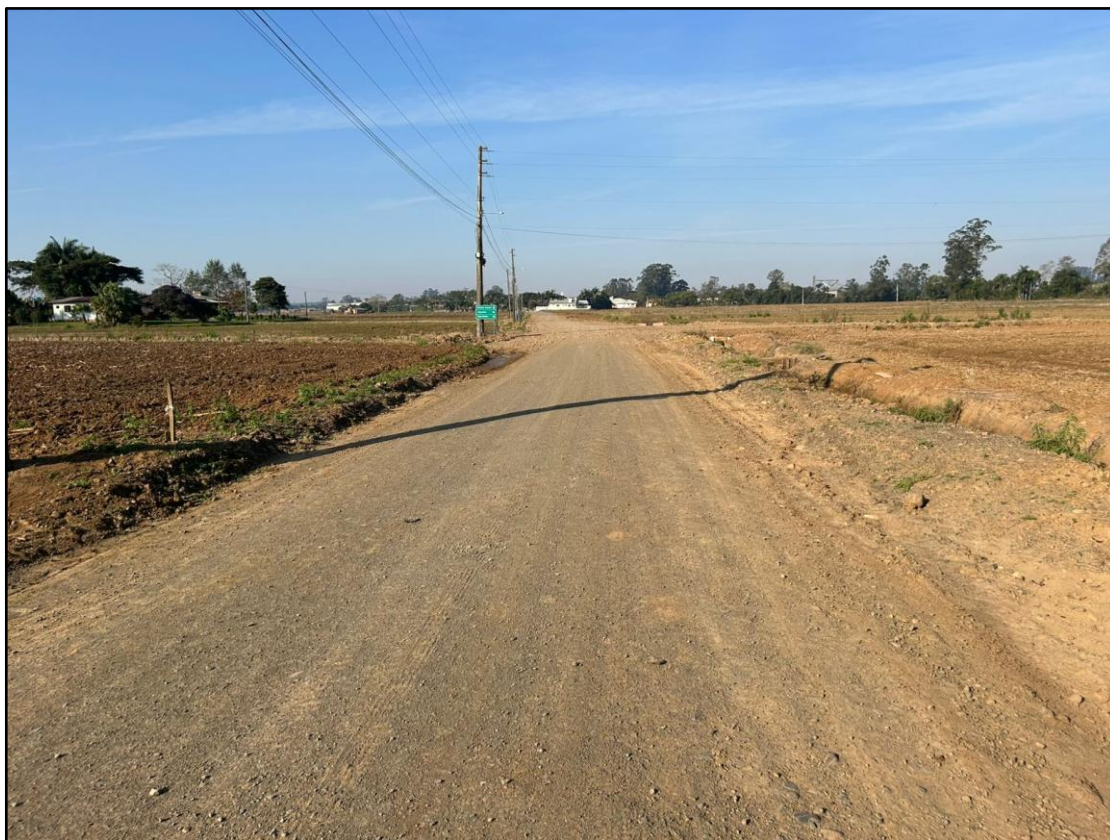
Trecho final da ERM 120 a ser pavimentado
